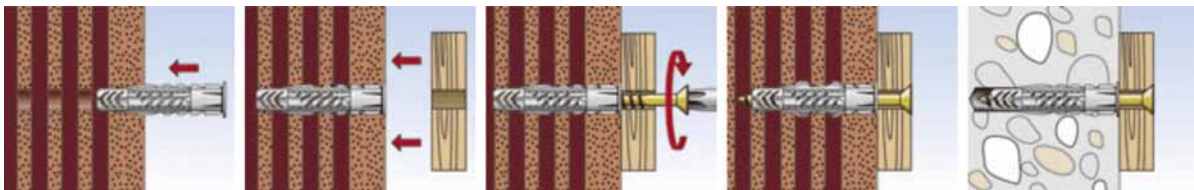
Монтажные наметки на пористом бетоне /обычном бетоне
